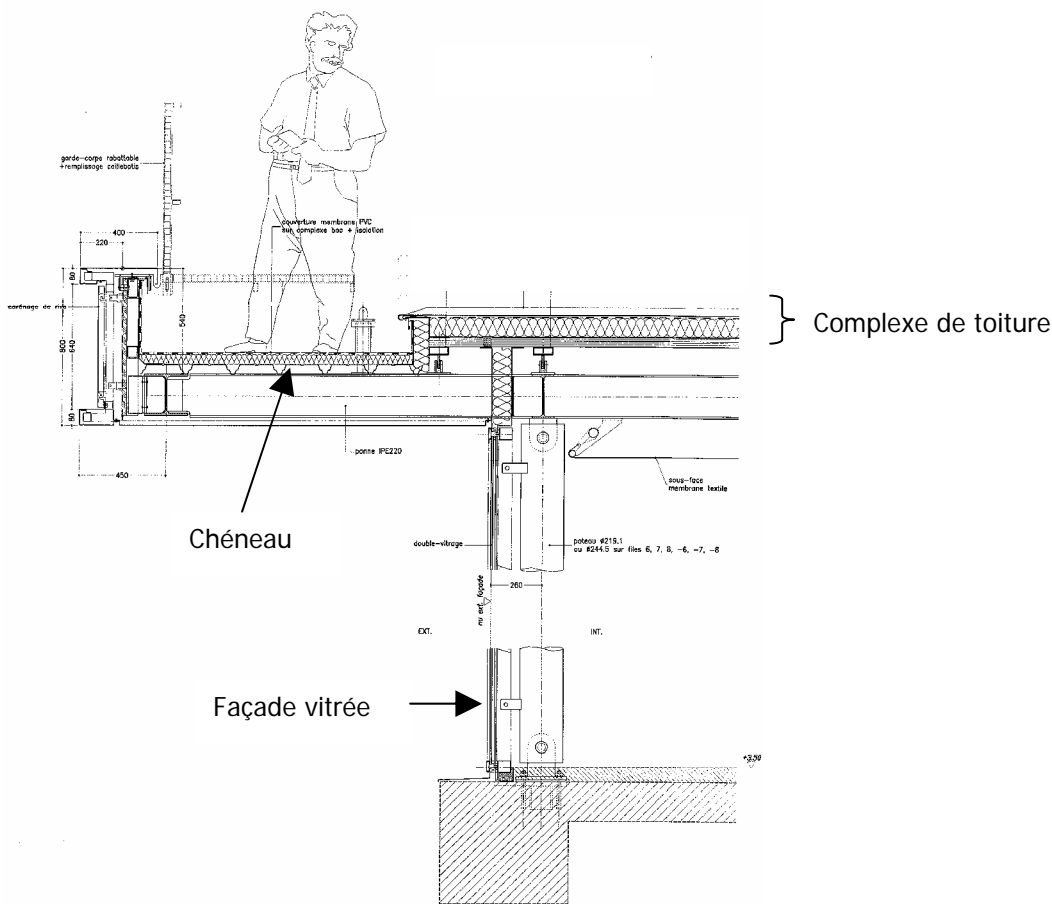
Rive de toiture et façade vitrée (plan Arcora)
